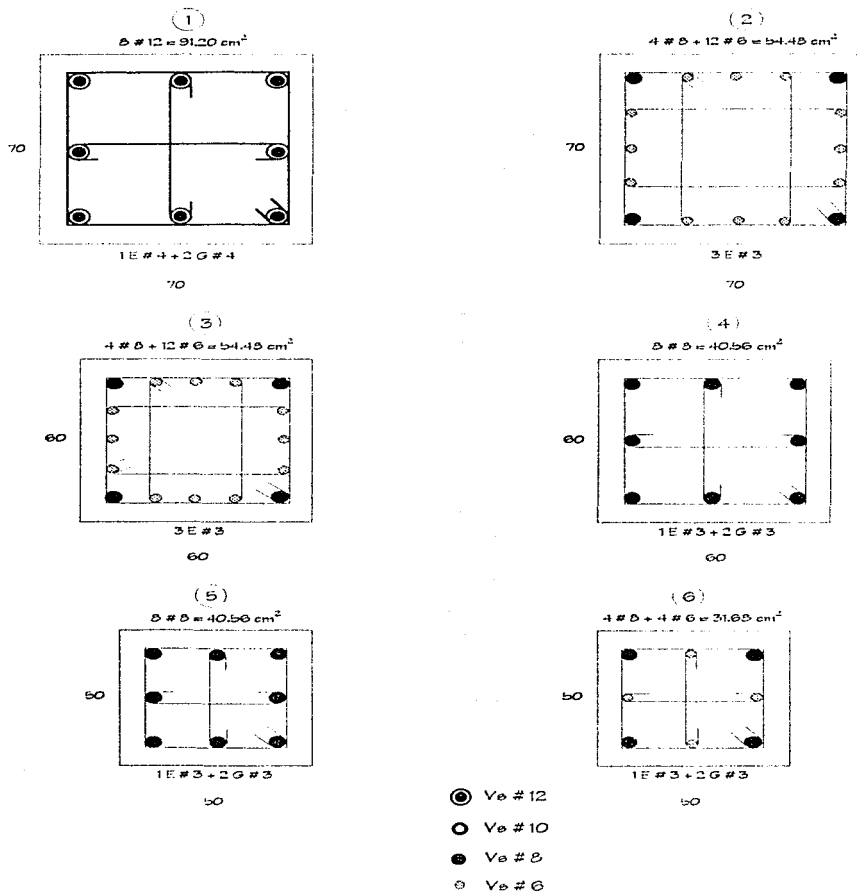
Tipos de armados de las columnas del eje 2, edificio de 7 niveles diseñado en la zona II
